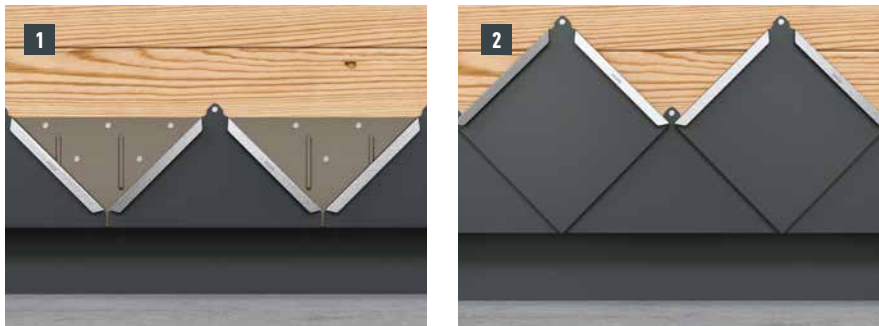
• Losange de façade 20 × 20 – sens de couverture et fixation
